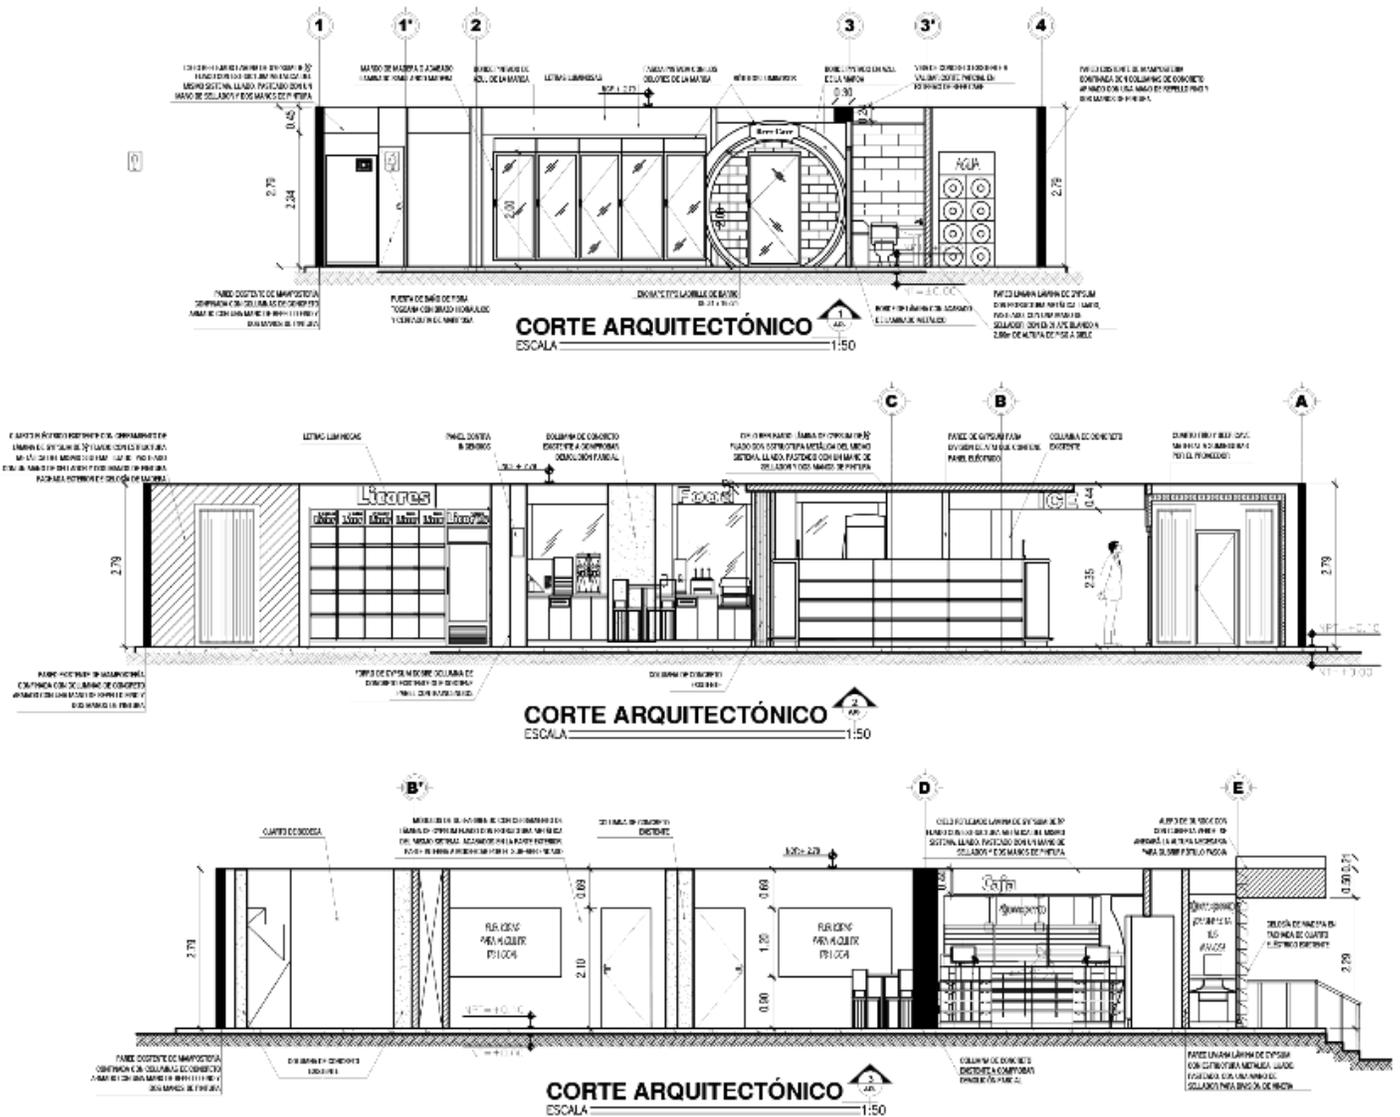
Planta Arquitectónica y elevaciones AM:PM 09 - Plaza Penta
